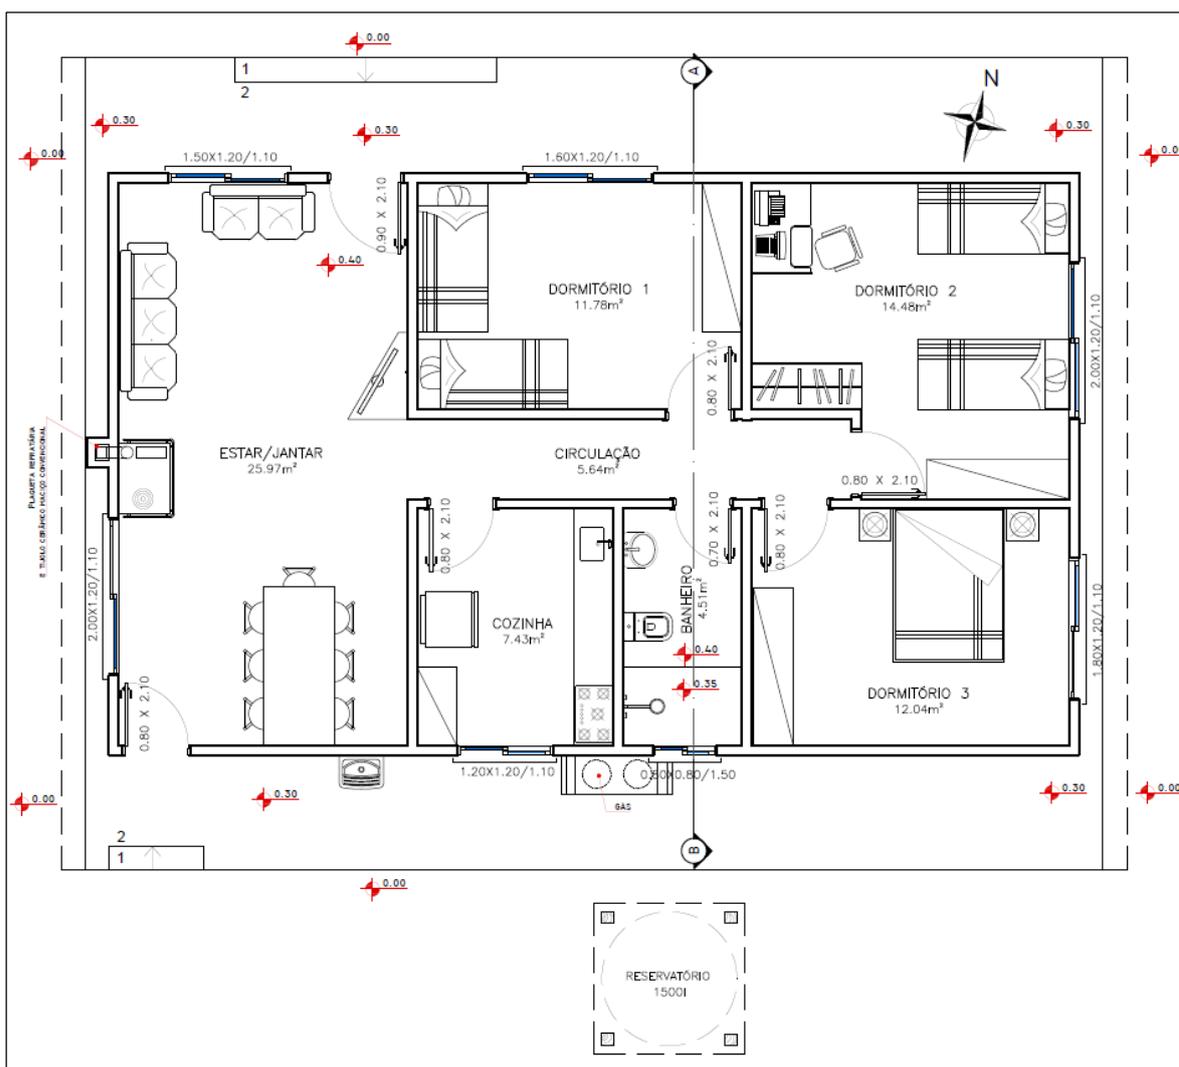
Croqui da planta baixa. Fonte: Elaborado pelos autores.
